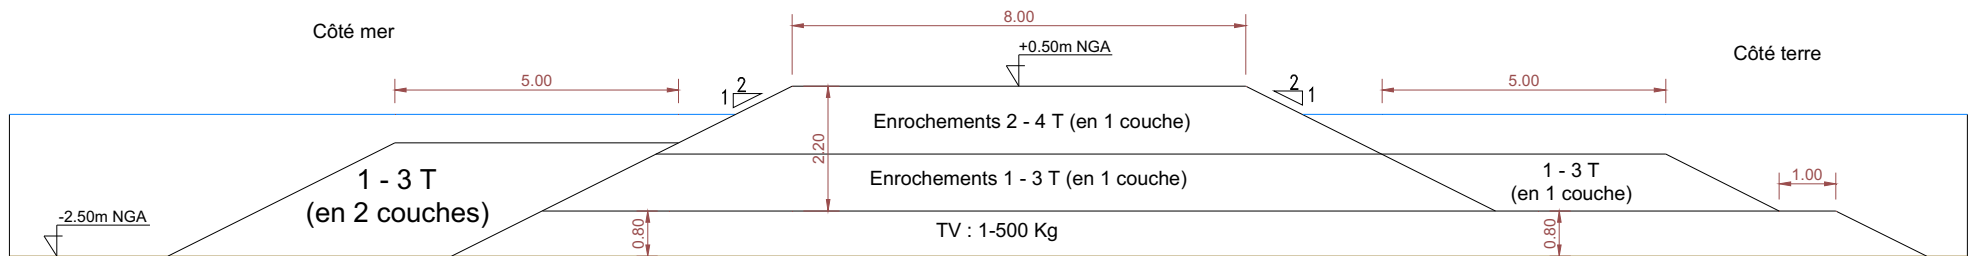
Profil type de la variante 2 de protection de Palm Beach (canal à houle).
